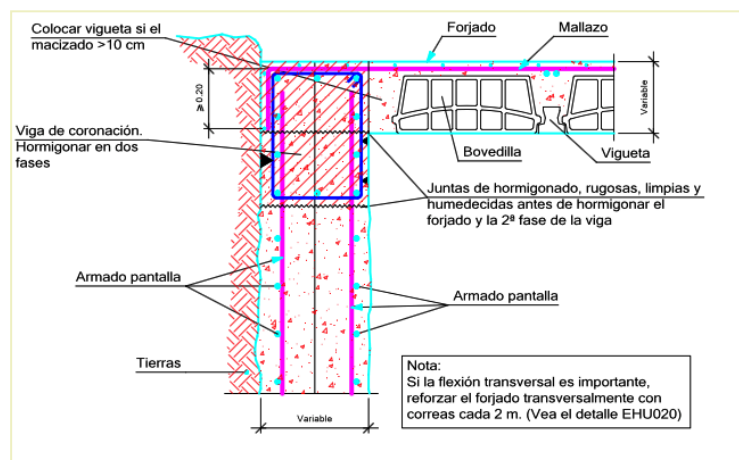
UNIÓN MURO DE SÓTANO Y FORJADO DE VIGUETAS
